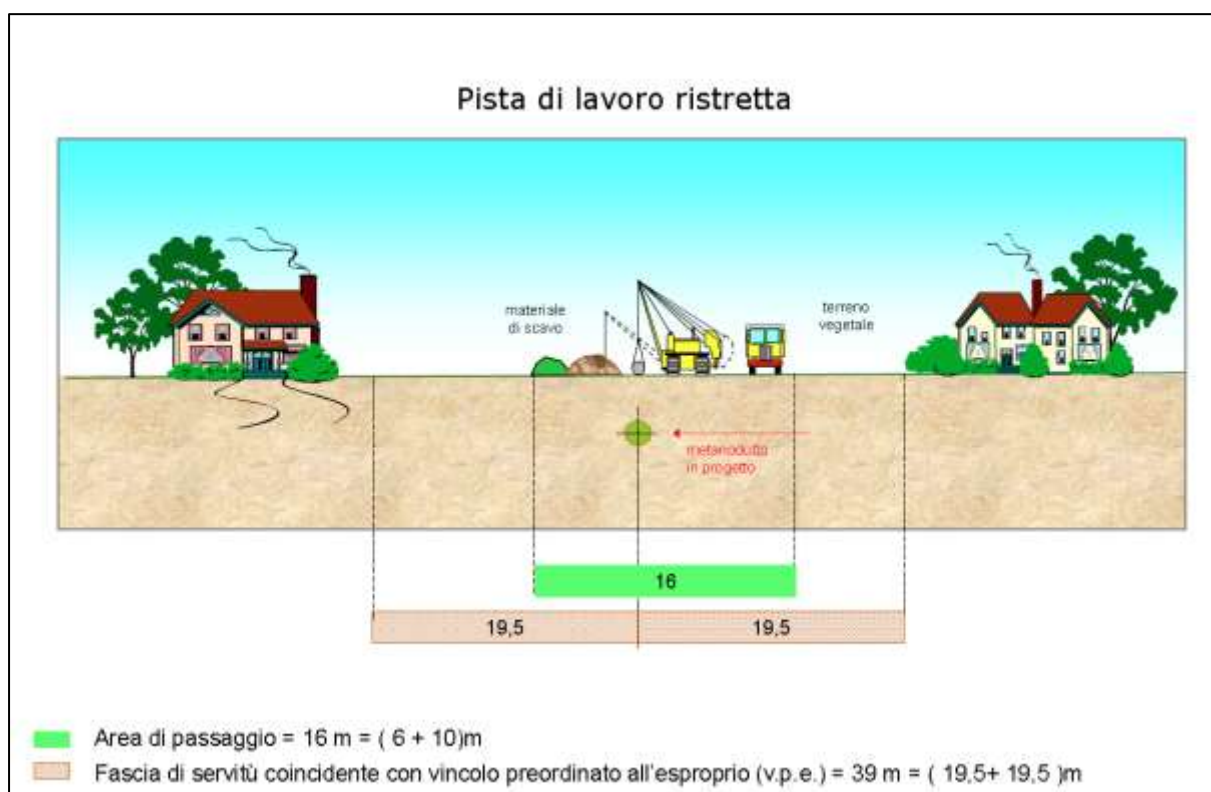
Fascia tipo con pista di lavoro ristretta - “Met. Sansepolcro – Foligno DN 400 (16”) – DP 75 bar”
